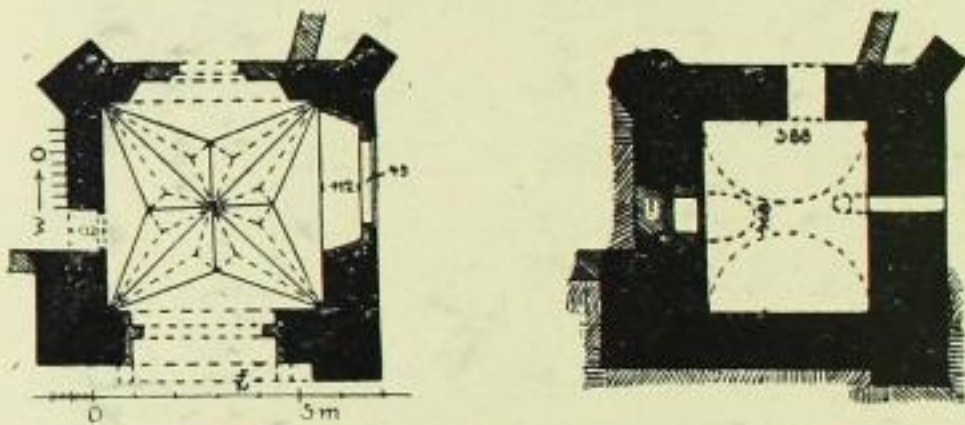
und 694. Jakobskapelle, Grundrisse des Erdgeschosses und Kellers.
